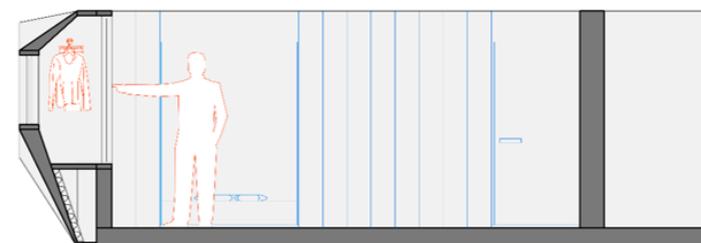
Detalle del espacio intermedio realizado en el departamento 705.
